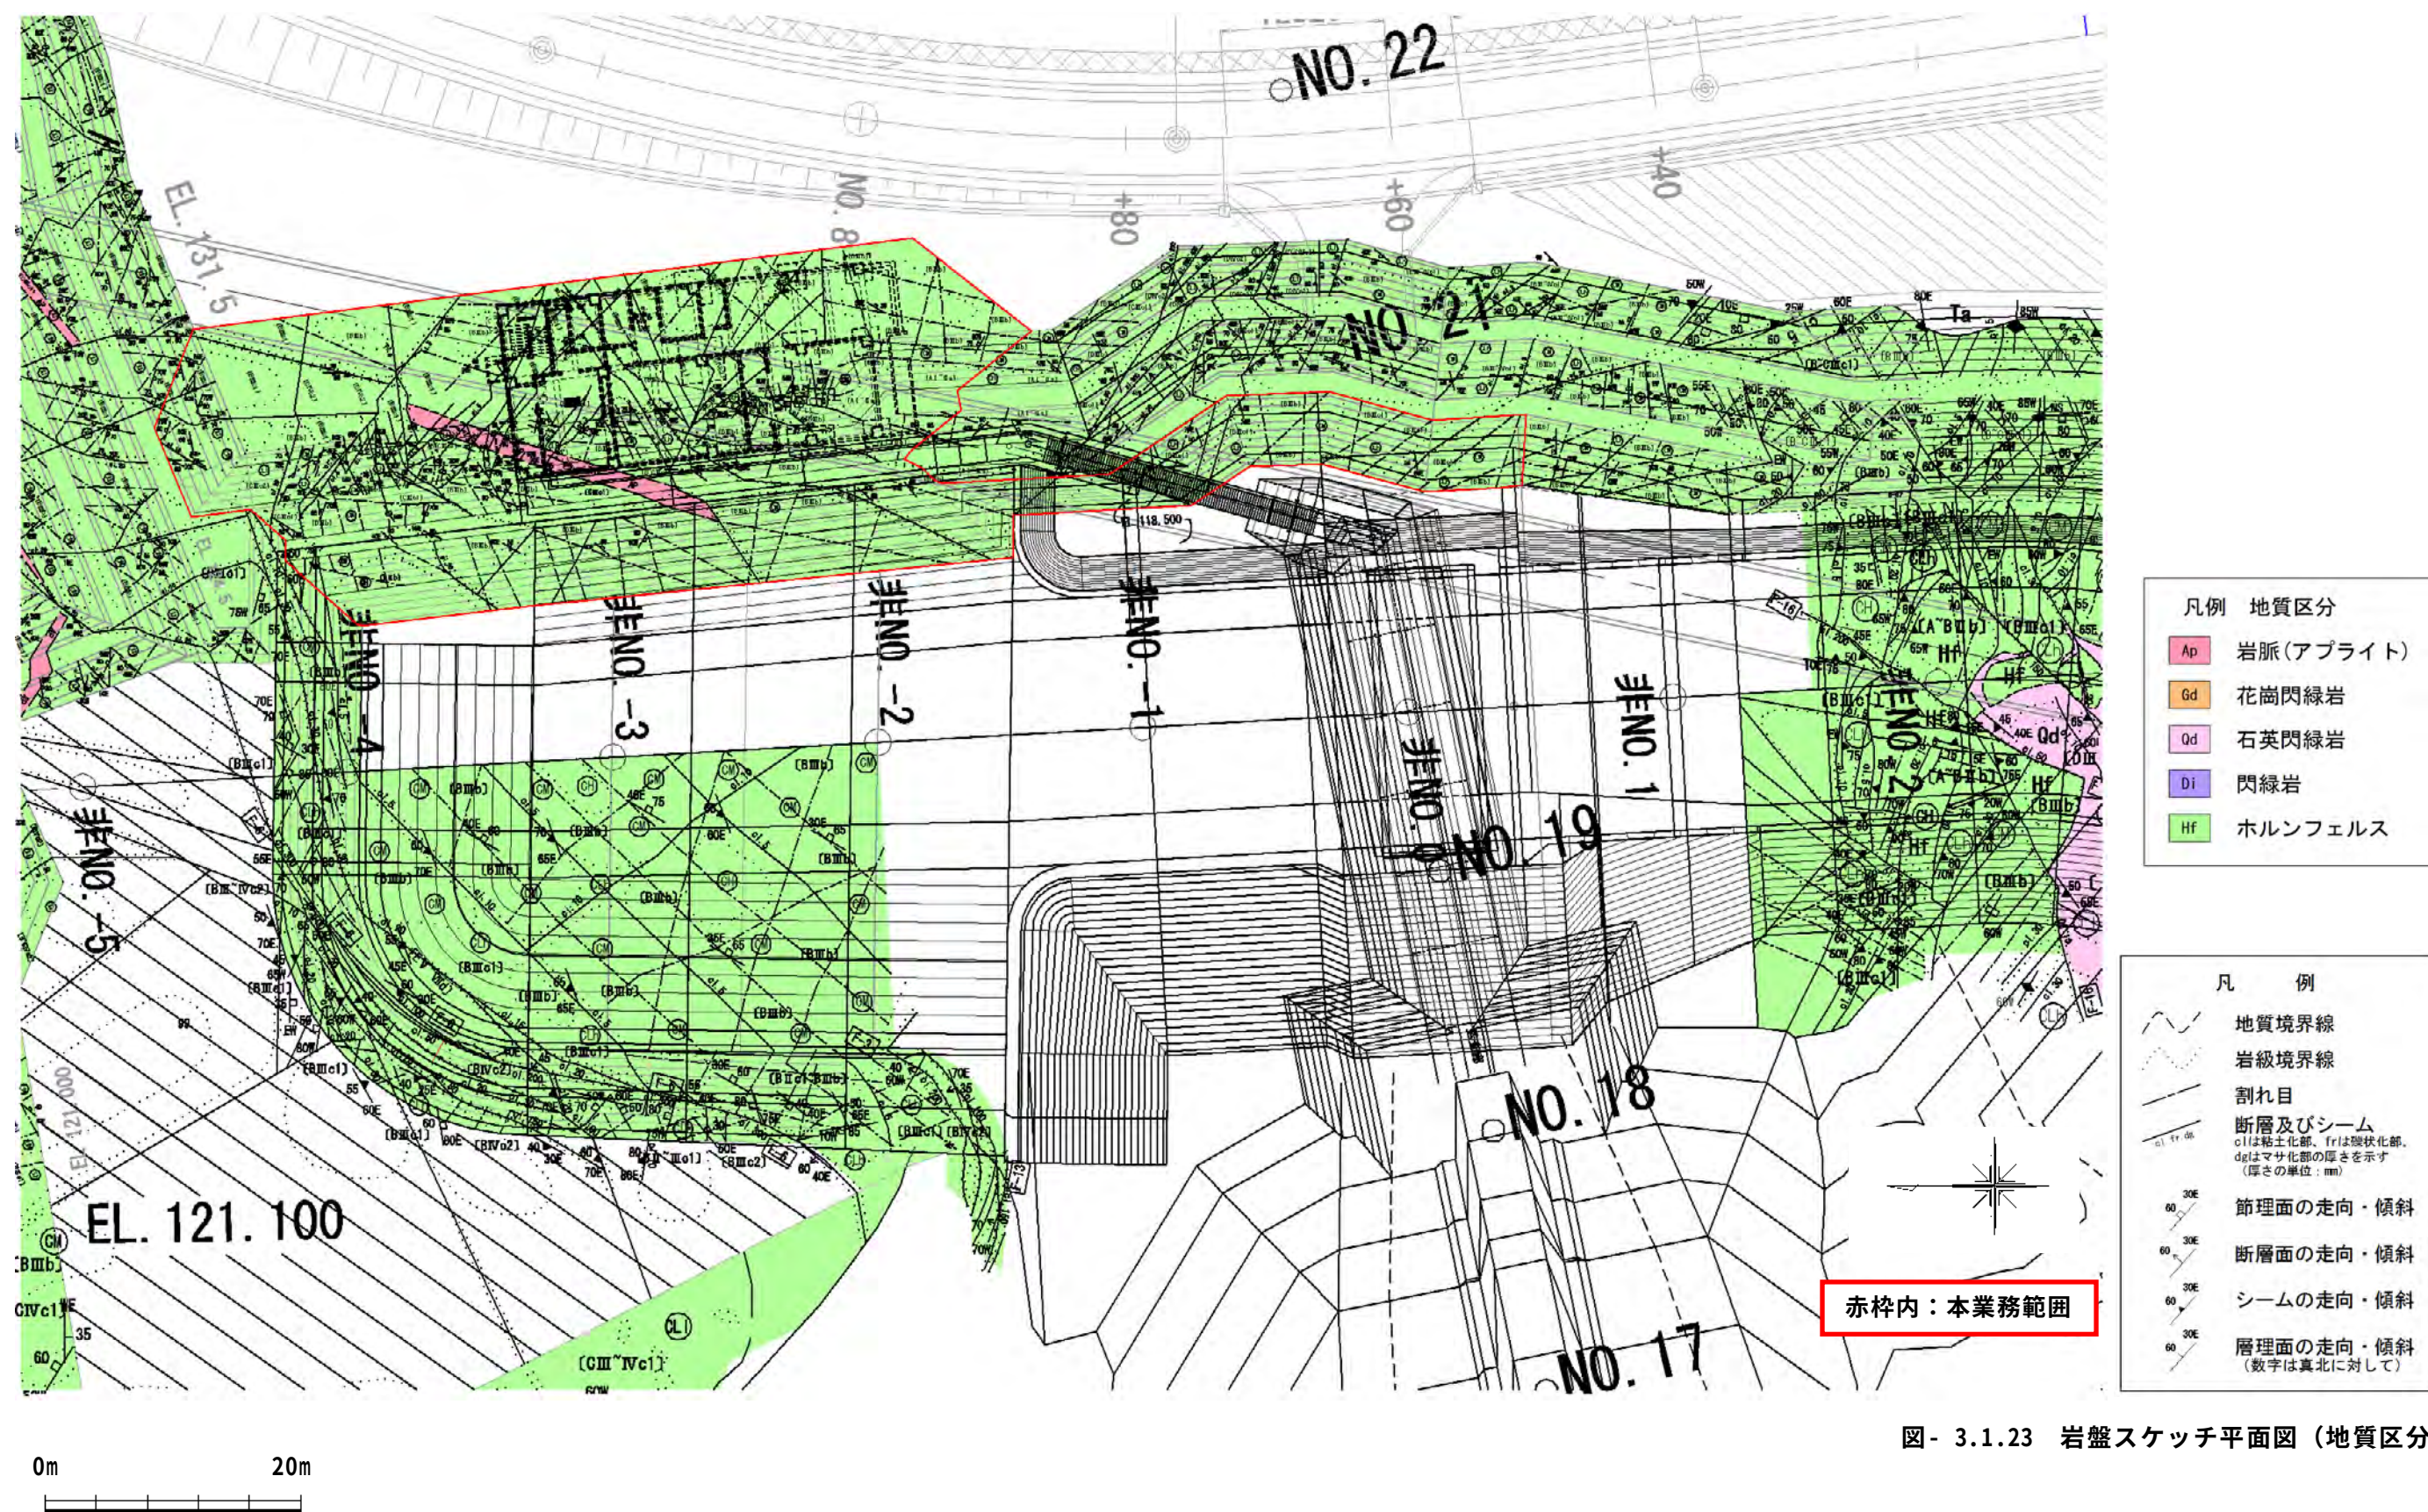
岩盤スケッチ平面図 (地質区分)
